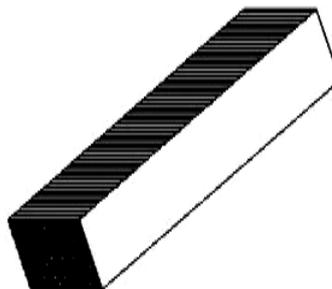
Perfil cuadrado (www.ConstruAprende.com)
